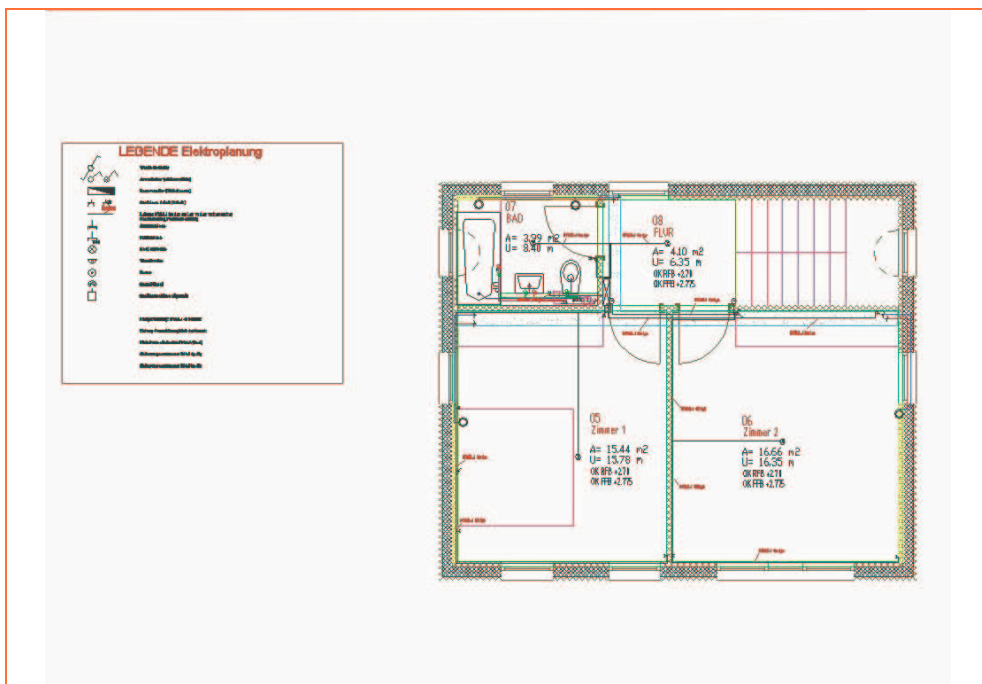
Mustergebäude, Grundriss OG
